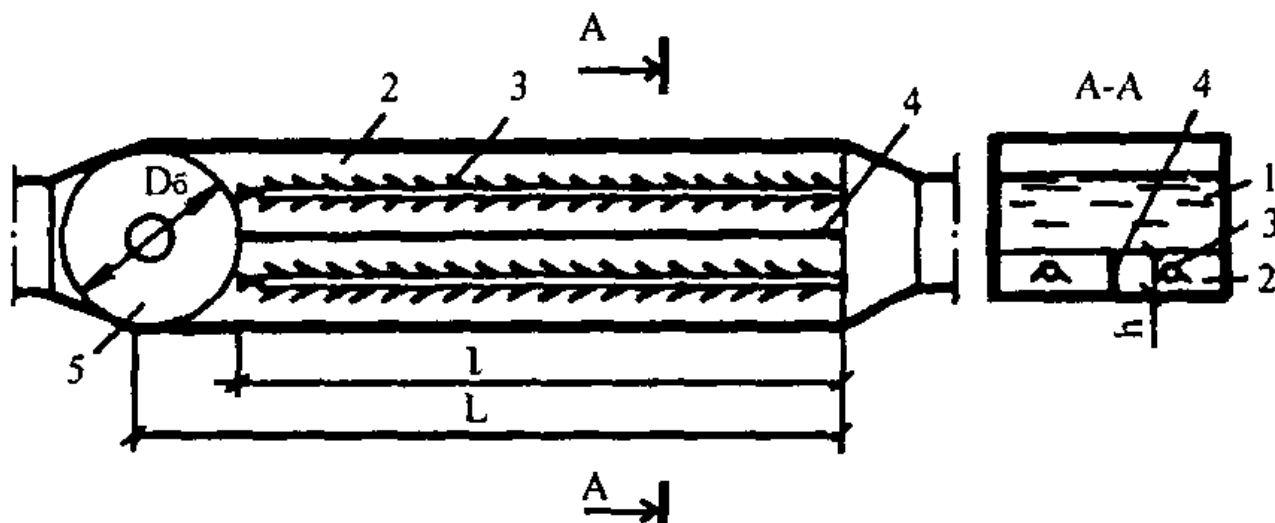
Схема горизонтальной песколовки: 1 - цепной скребковый механизм; 2 - гидроэлеватор
